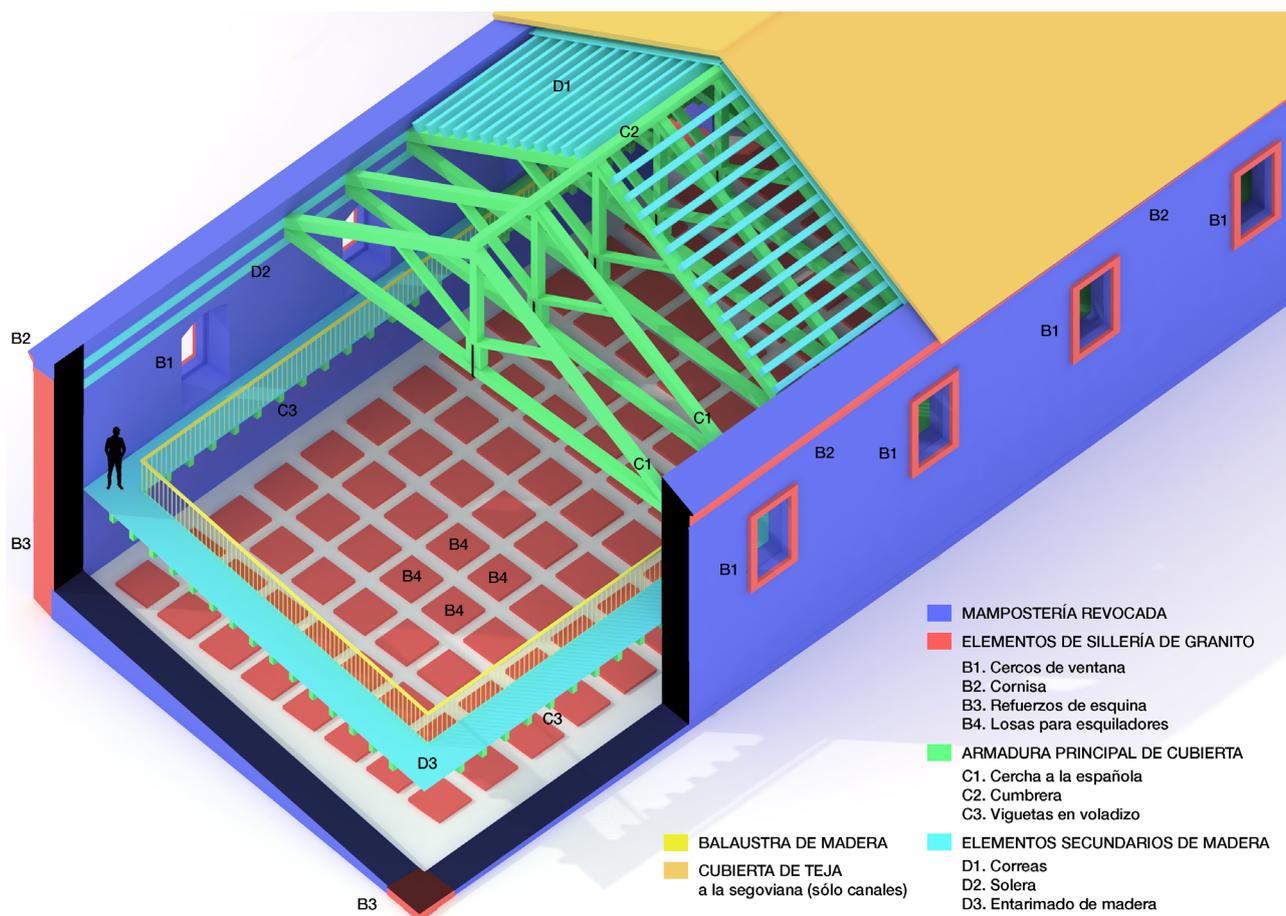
Sistema constructivo y compositivo del rancho situado en el núcleo central.
